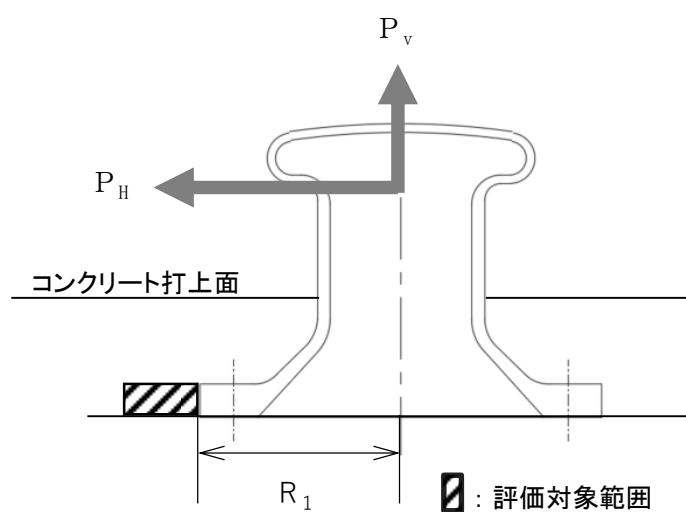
コンクリート（係船柱前面）のモデル図
